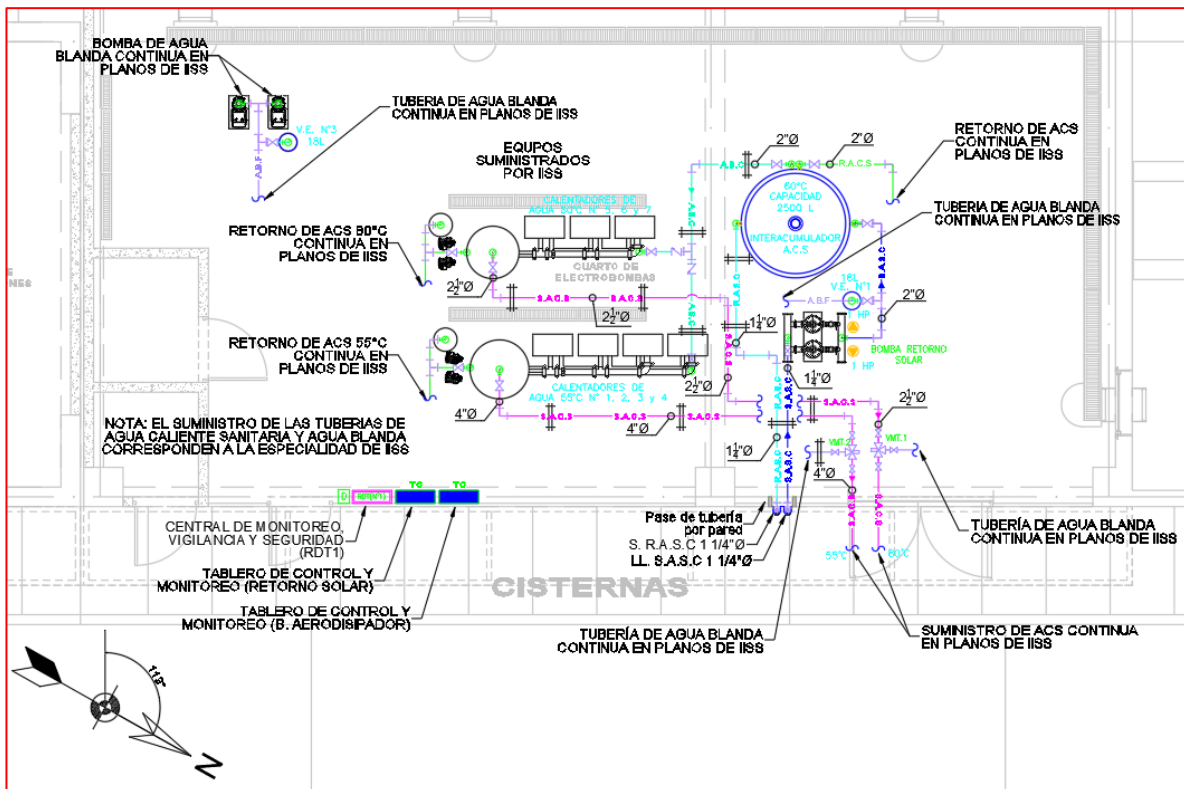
Esquema de planta ubicado en la casa de fuerza
